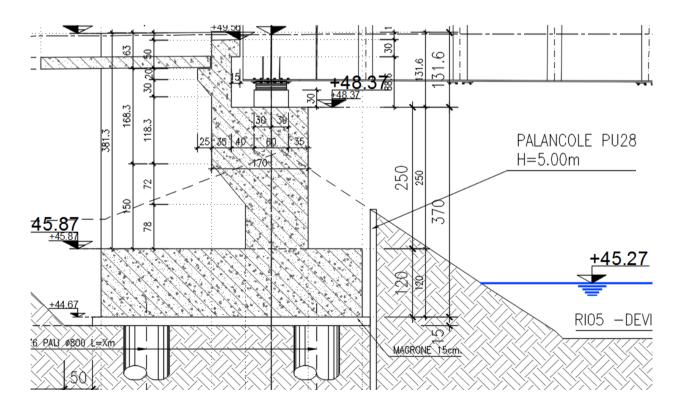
Sezione longitudinale della spalla A con indicazione delle palancole provvisionali
